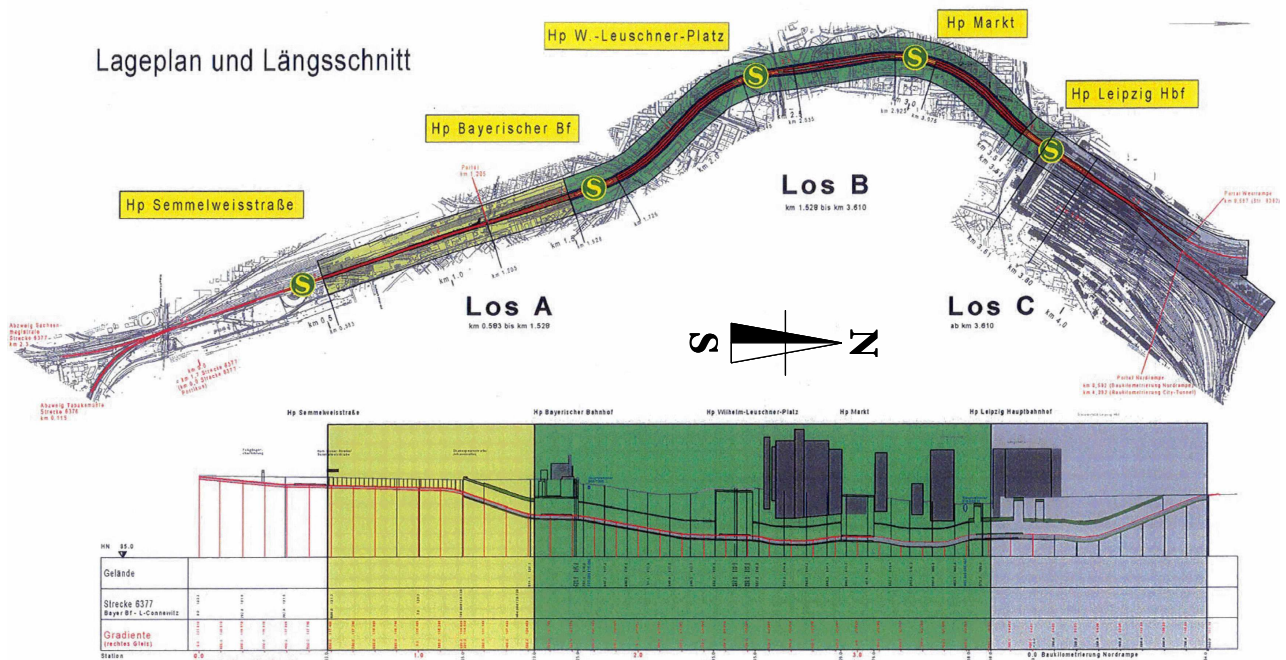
Draufsicht und Längsschnitt – Tunnelstrecke einschl. Rampen
